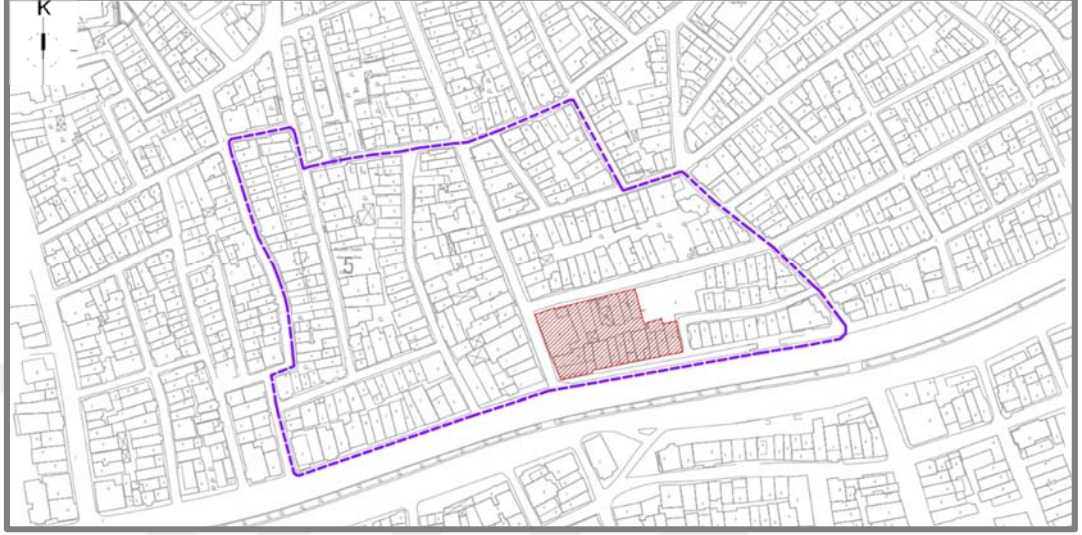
362 ada 2007 onaylı avan projenin vaziyet planı [4]
